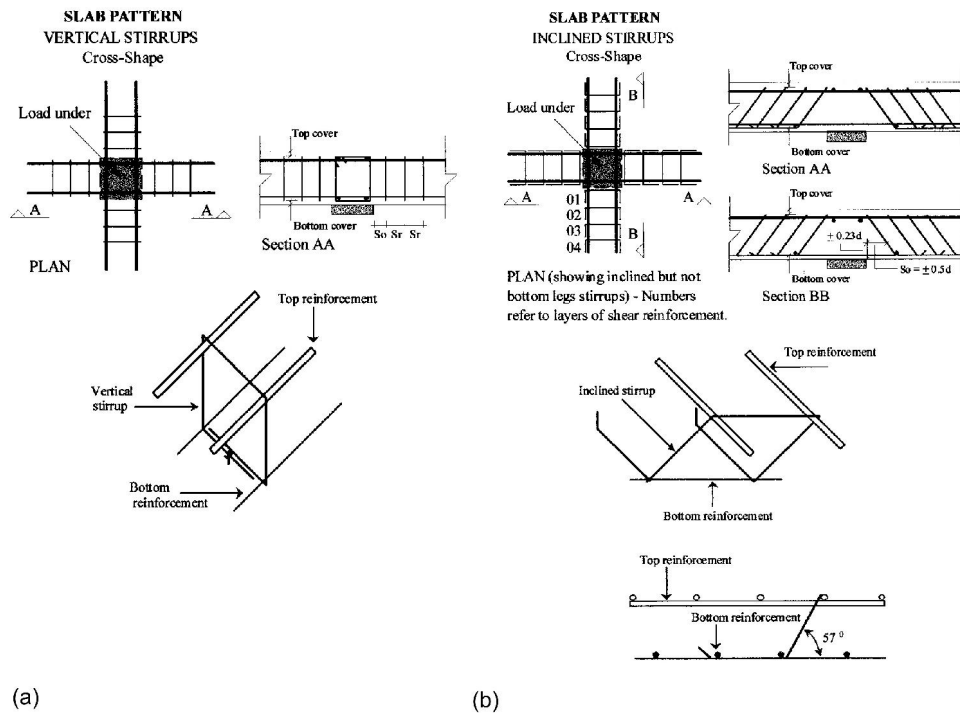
Armaduras de punçoamento: (a) Estribos verticais; (b) Estribos inclinados [53].
